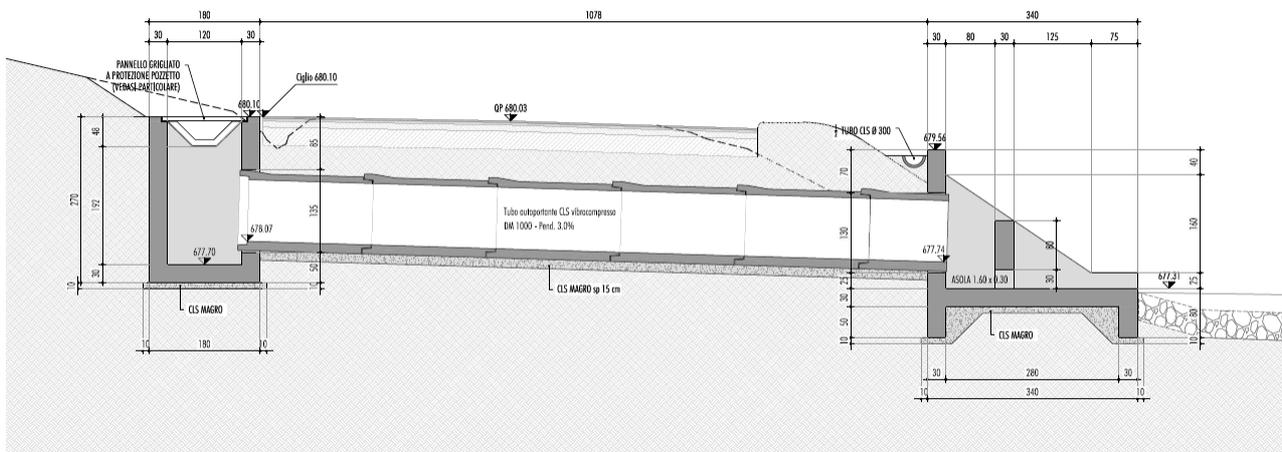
ATTRAVERSAMENTO IDRAULICO TIPO
